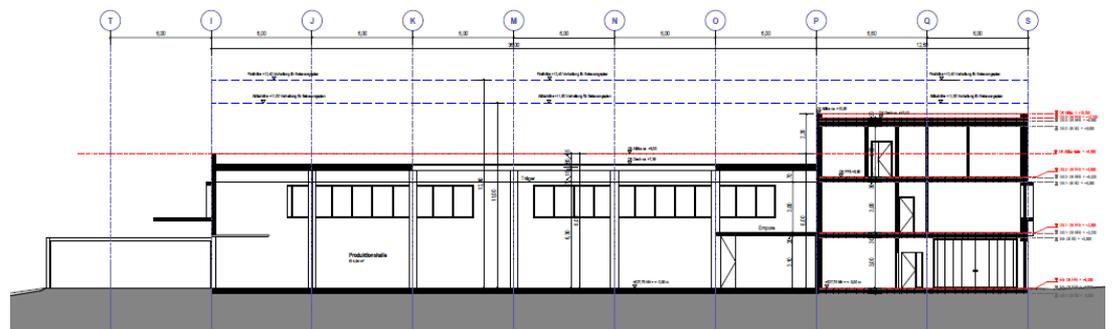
Schnitt des neugeplanten Reichenbach GmbH Gebäude (Vorabzug Vorentwurf, 2023), © Heene + Pröbst Consulting GmbH
